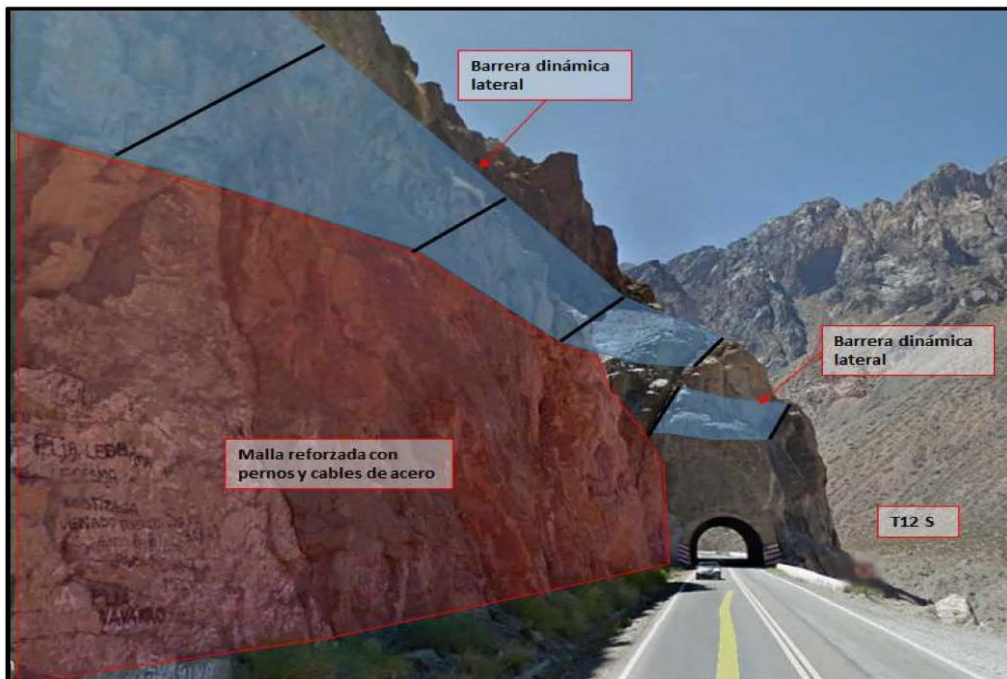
Esquema de protección de laderas propuesto para el portal salida del túnel 12.
